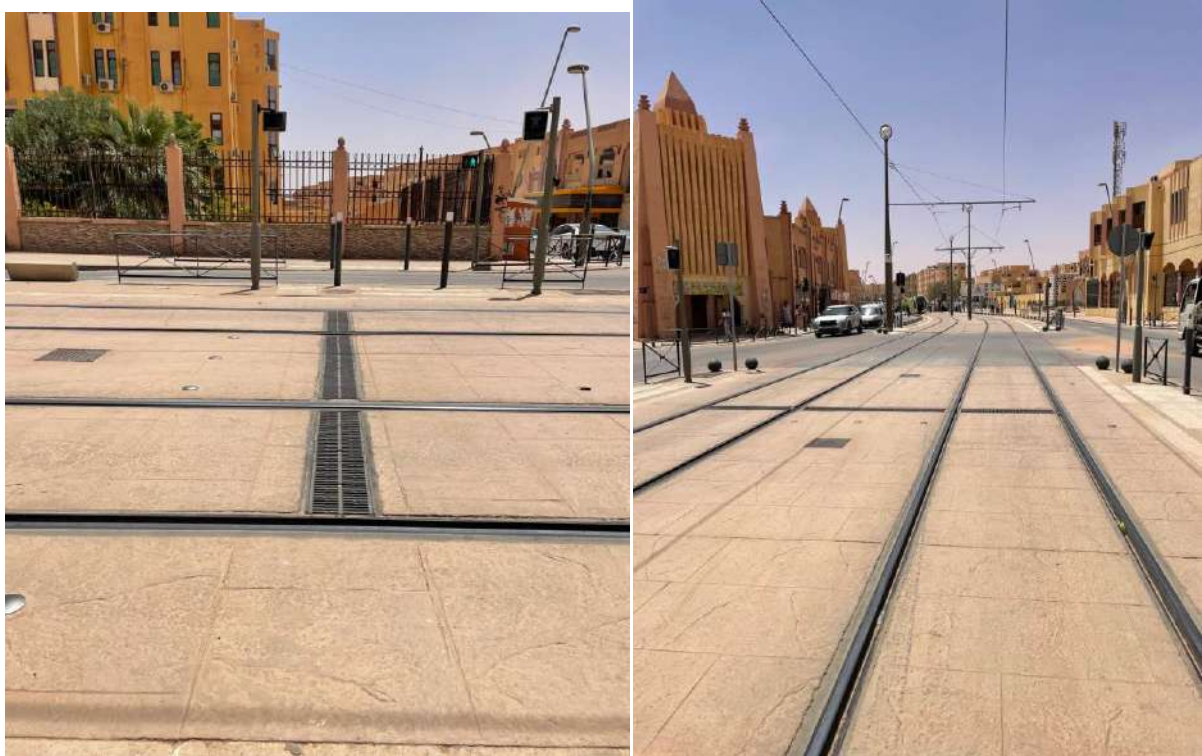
17): Caniveau pluvial transversal collectant les eaux drainées par les lignes de tramway vers le réseau d'assainissement.
